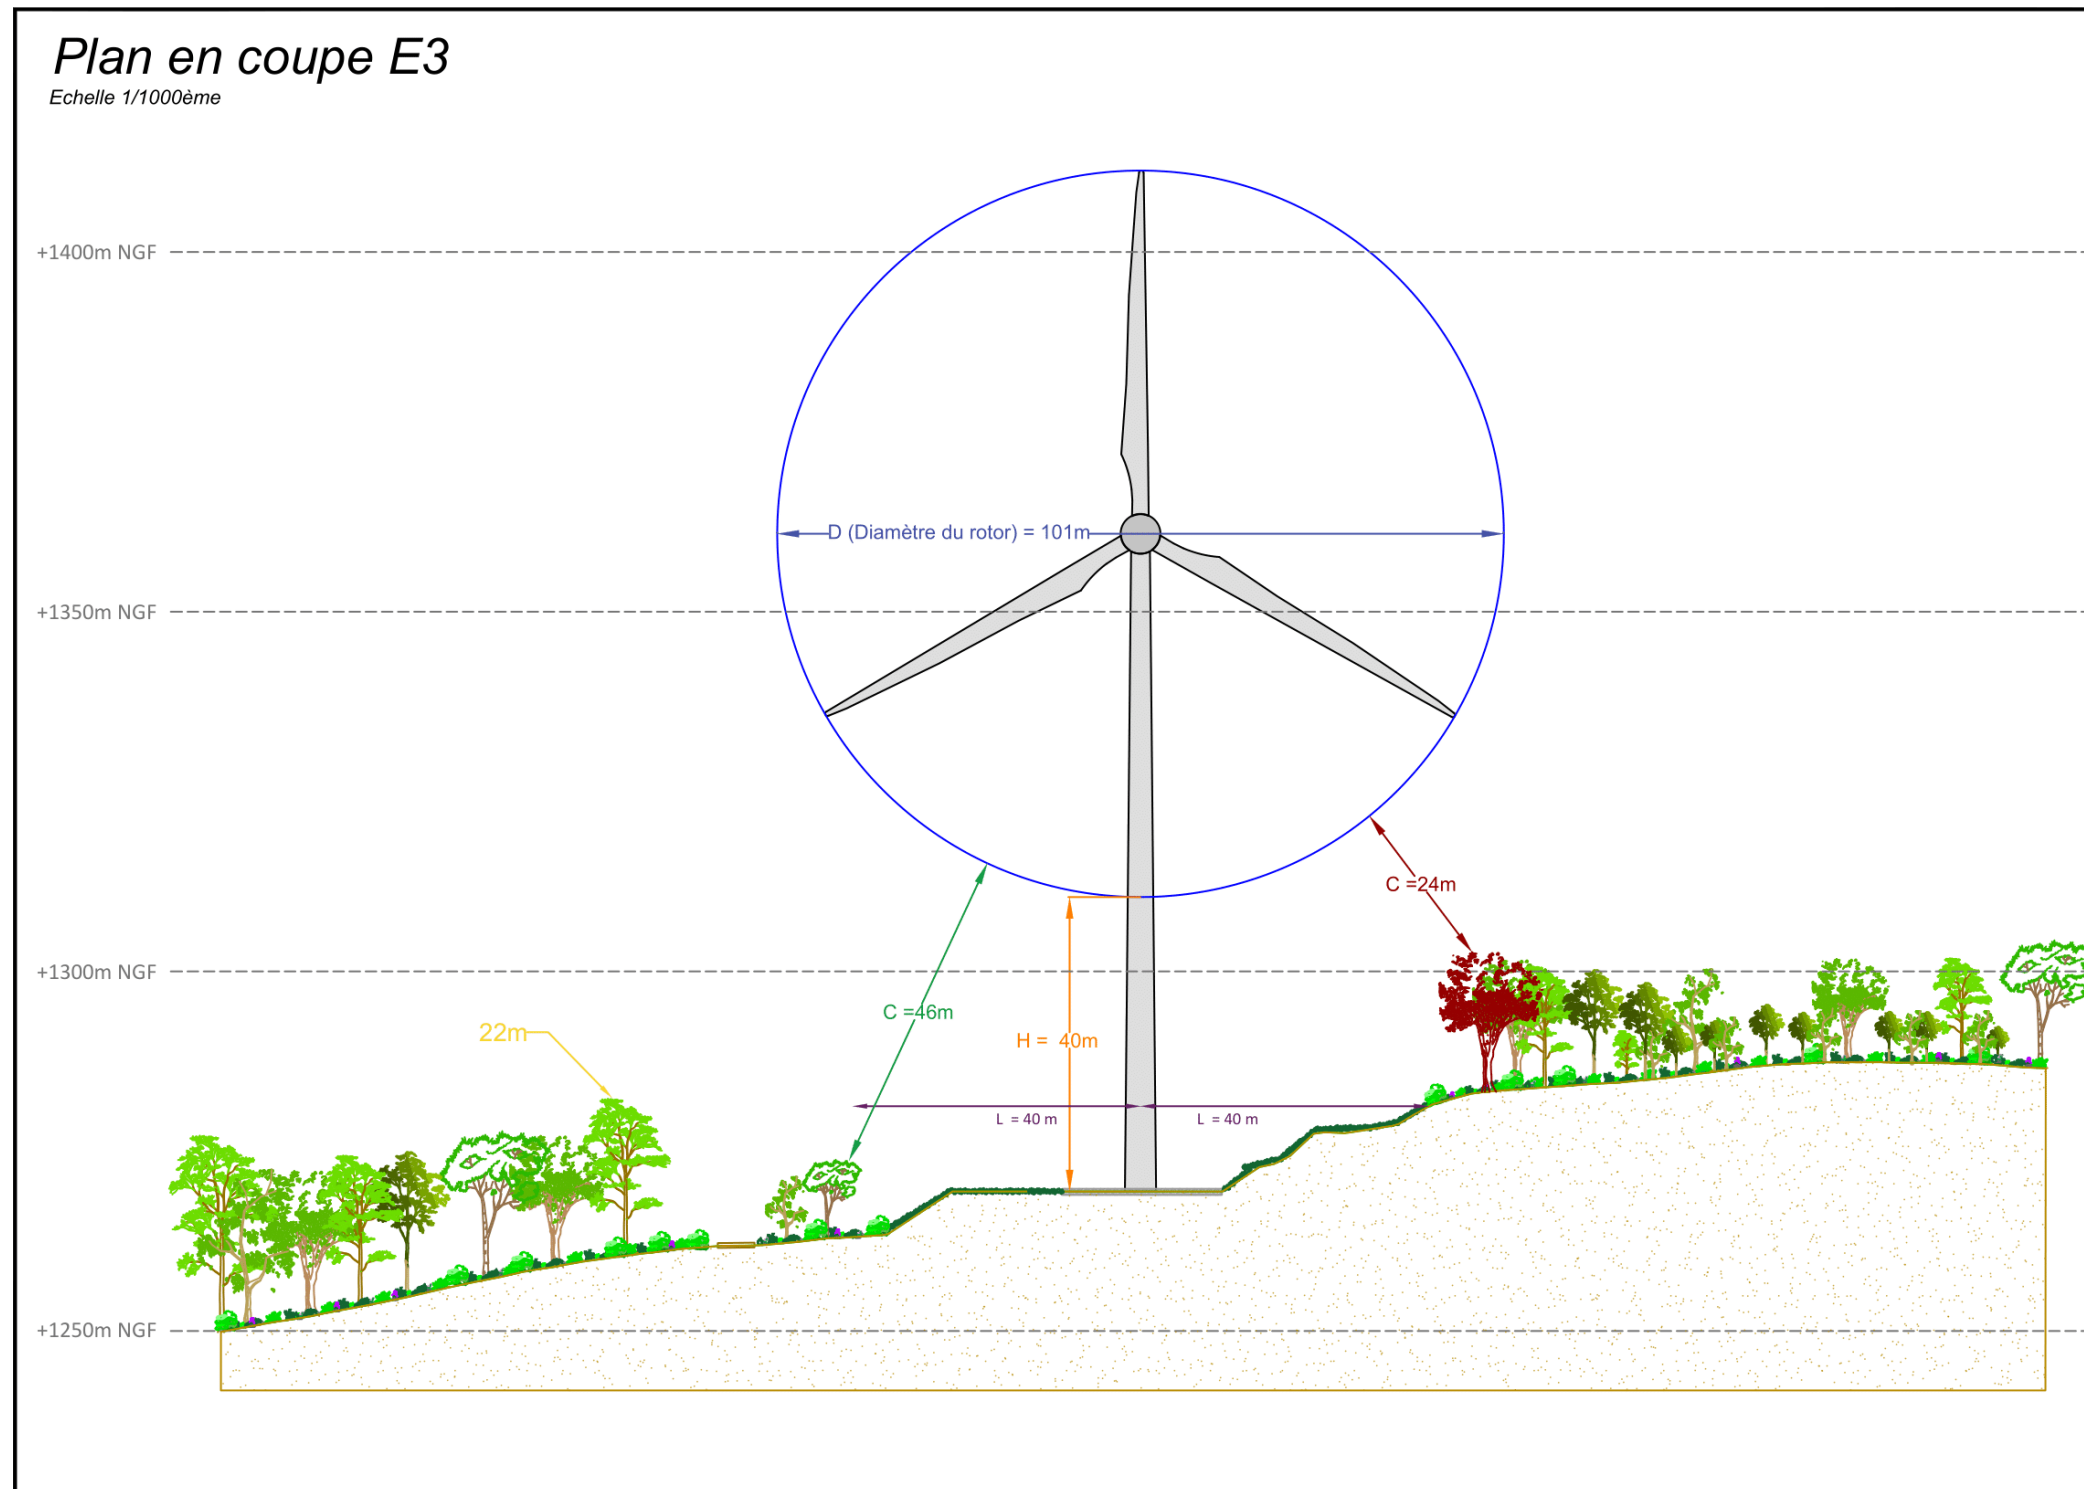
Plan de coupe et distance aux lisières (éolienne E3)
